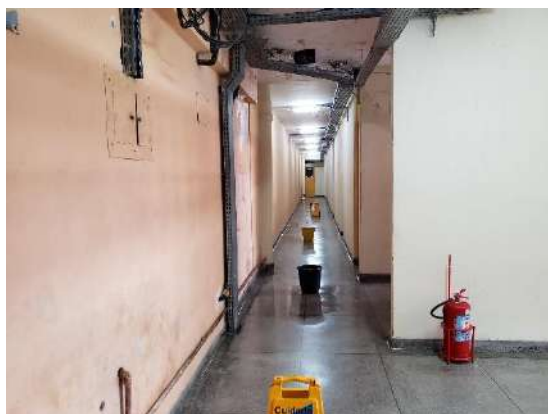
Vários pontos de vazamentos da cobertura em corredor interno do térreo.
